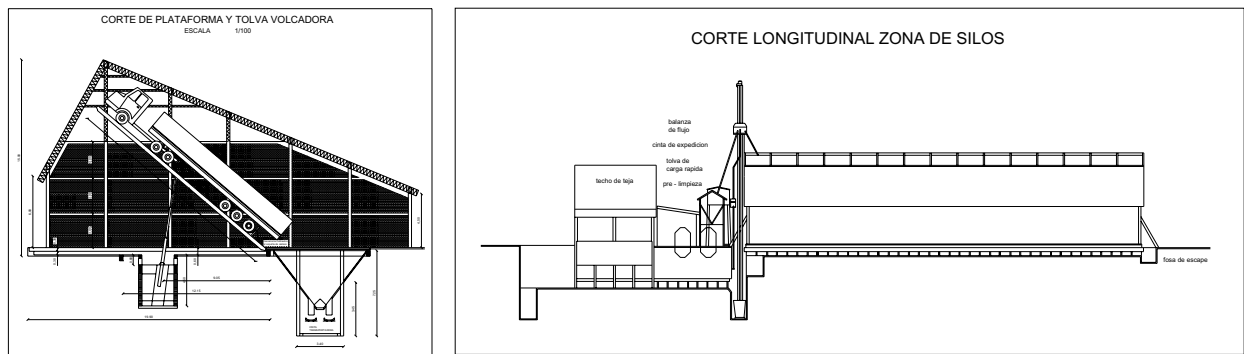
Plano de Sección Transversal de las Principales Instalaciones
